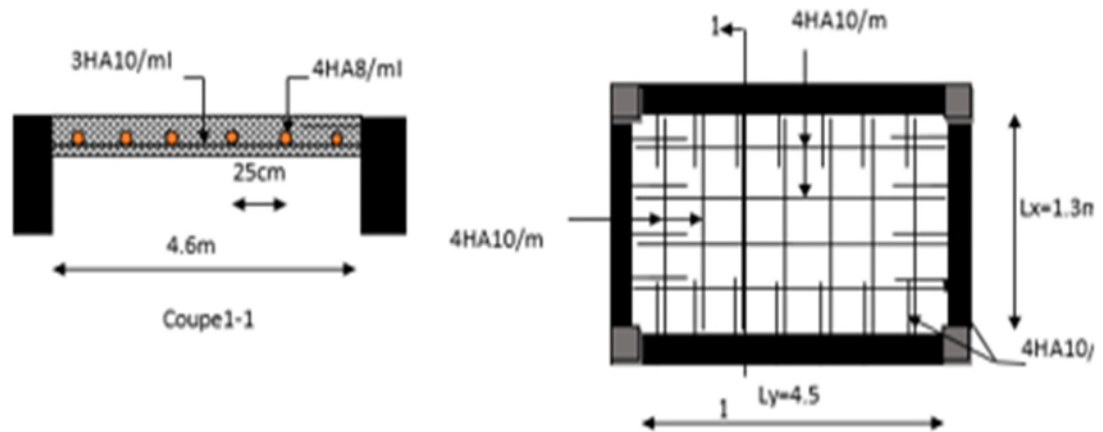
Schéma de ferrailages de dalle sur 4 appuis d'étages courante
